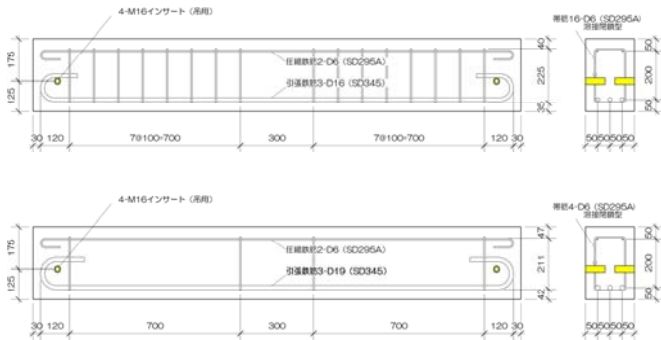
供試体構造一般図(上 : 曲げ, 下 : せん断)
